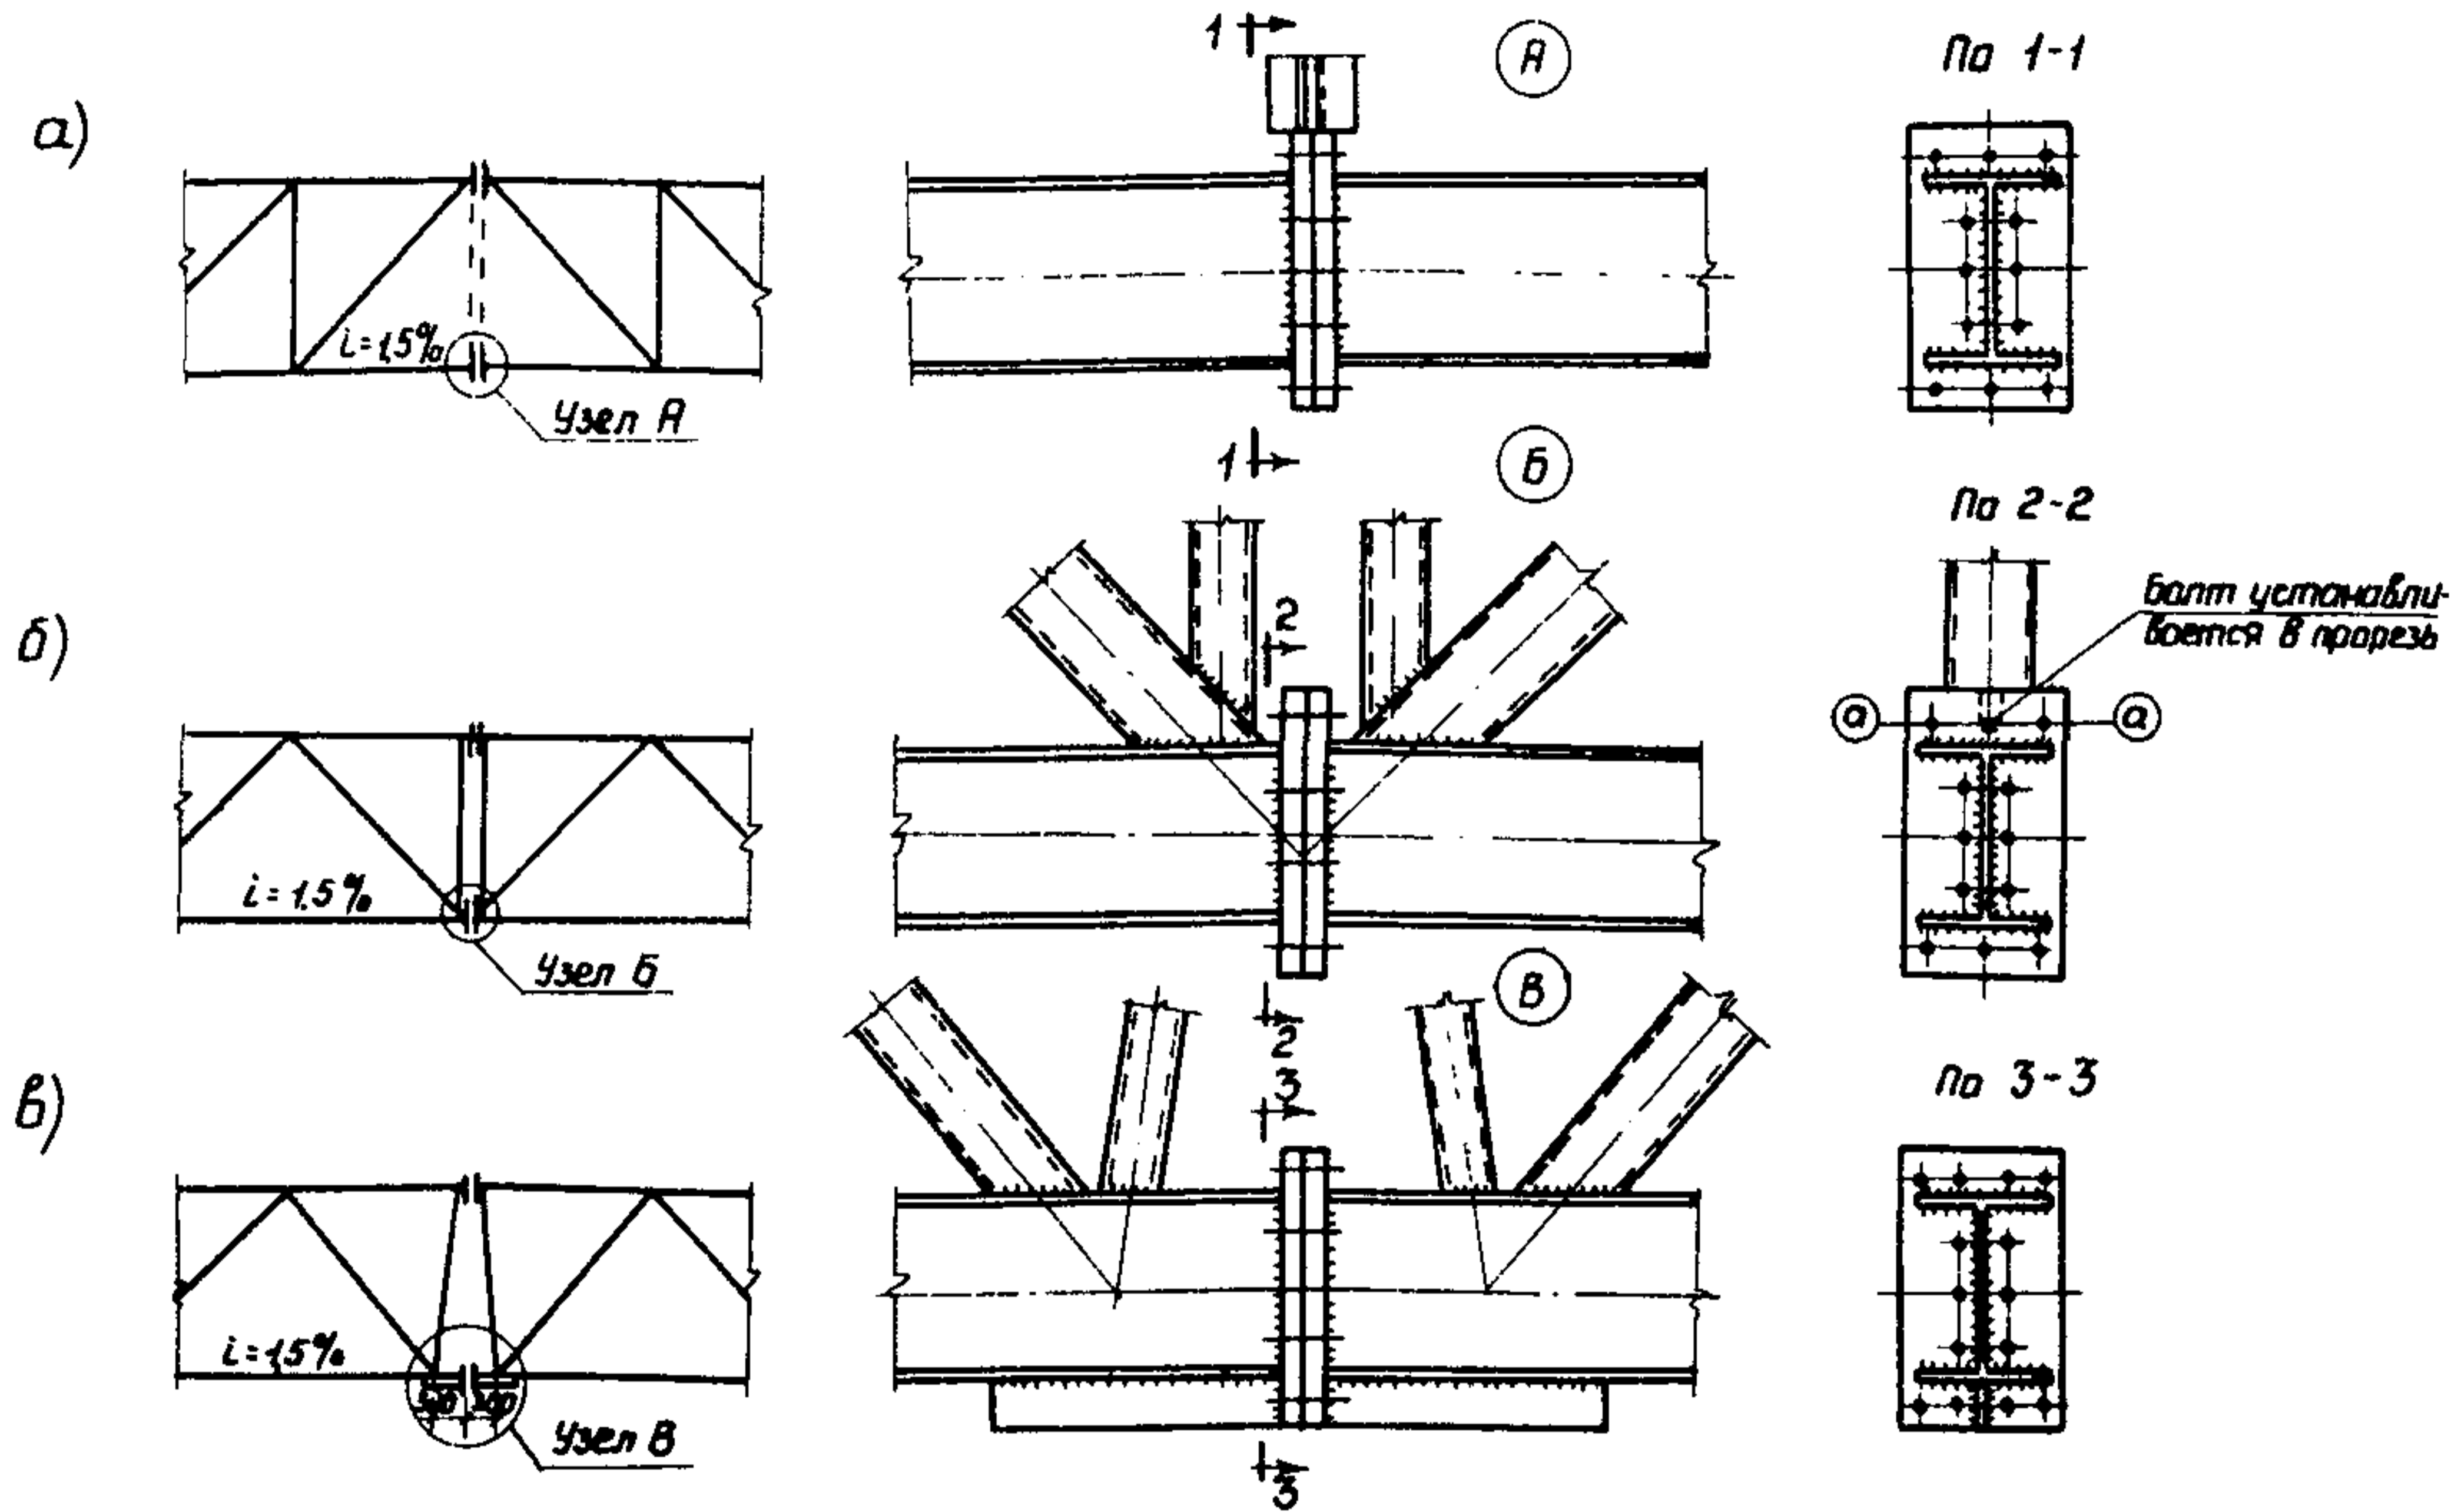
Рис. I. Рекомендуемые конструктивные решения фланцевых соединений растянутых (нижних) поясов стропильных ферм
